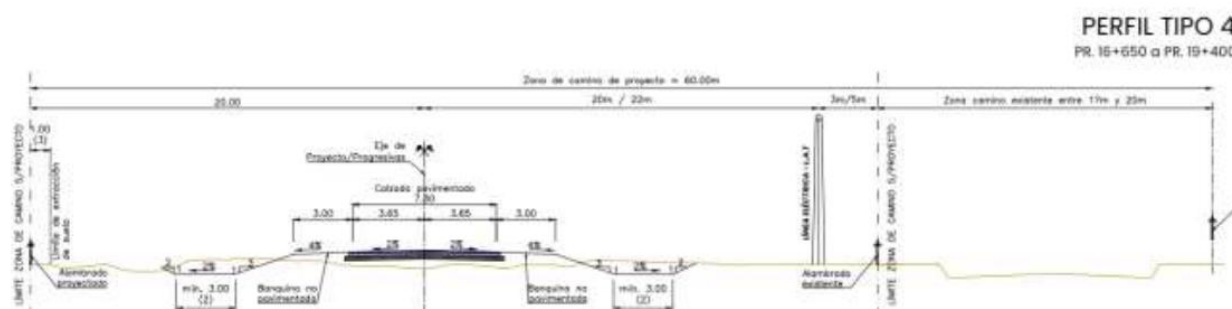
Perfil Tipo 4 – Rural – 16+650 a 19+400
